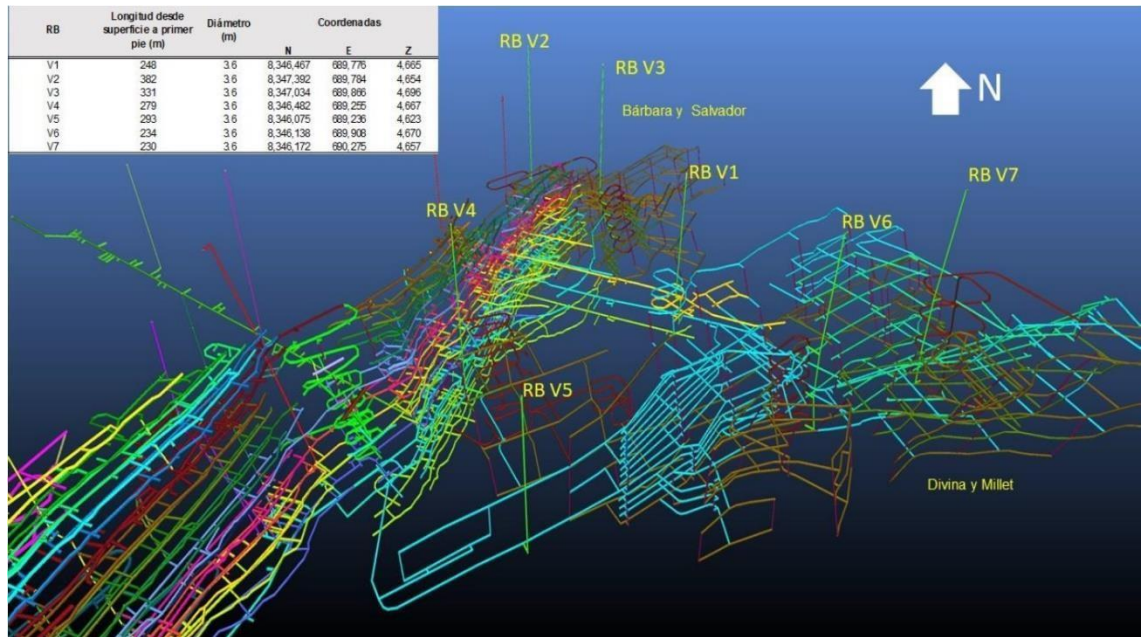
Ubicación de los RB de ventilación proyectados para la nueva infraestructura de minado de las vetas Salvadora, Bárbara, Millet y Divina
